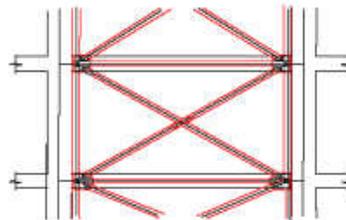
Esquema de Refuerzo Diagonales Metálicas de Fachada
